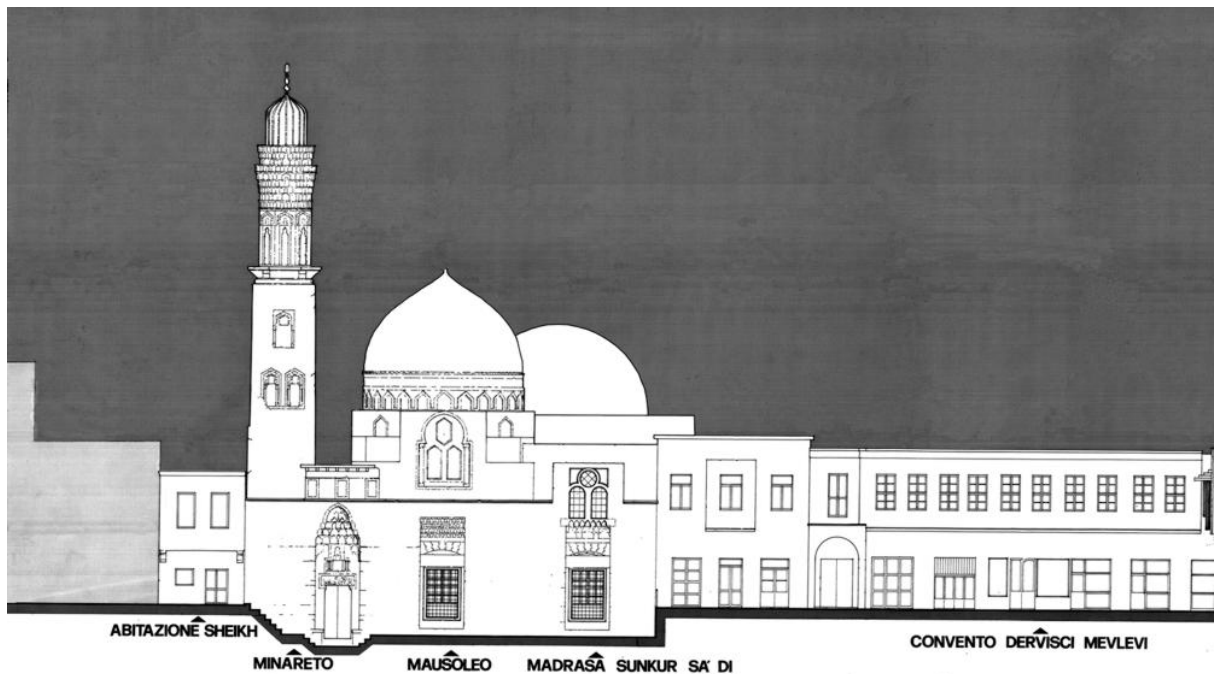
Sezione A-A de la Fachada del Complejo (Fuente: <http://www.cfpr.it/PLANIMETRIE%202009/Section.htm>)
